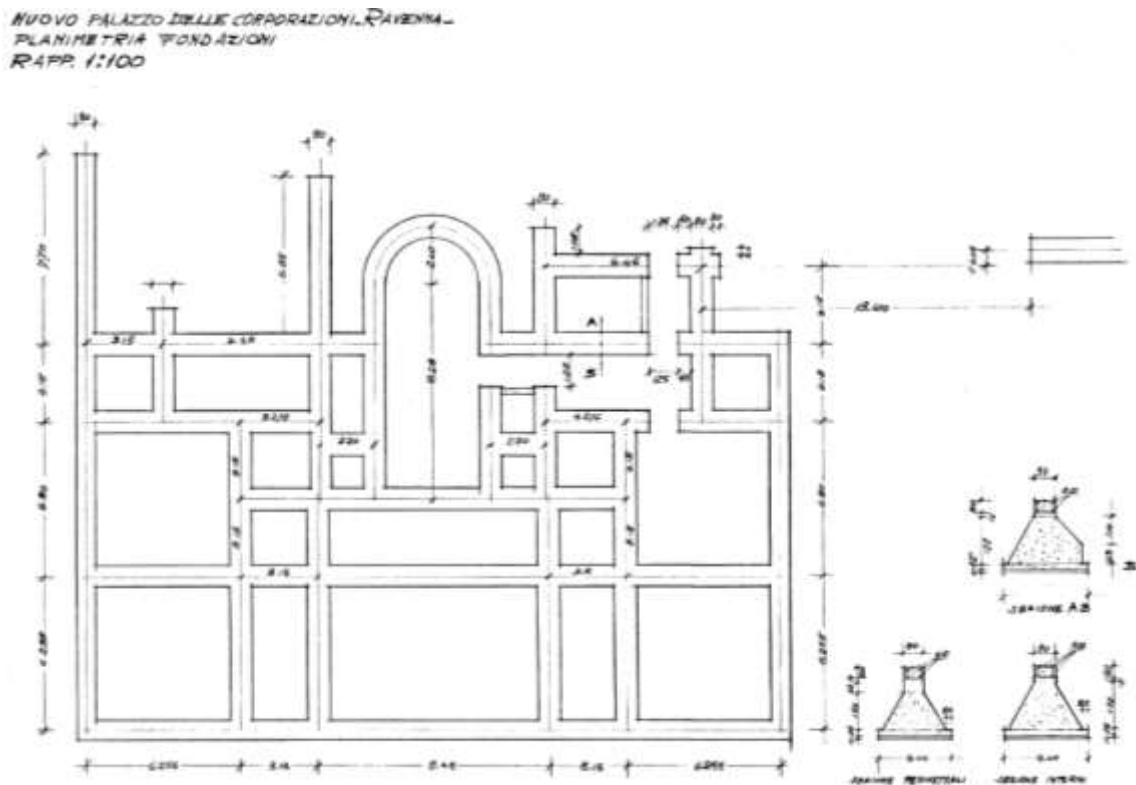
Pianta delle fondazioni e indicazione delle sezioni adottate per le travi di fondazione; analoga alla tavola di Figura 7.21 (progetto preliminare).
